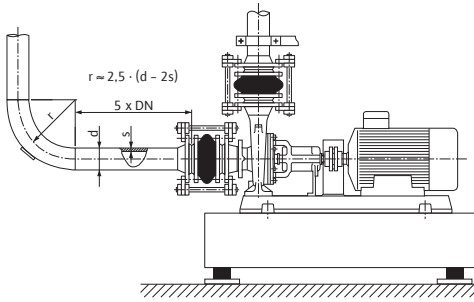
Collegamento della pompa senza tensioni meccaniche, percorso di stabilizzazione a monte e a valle della pompa
